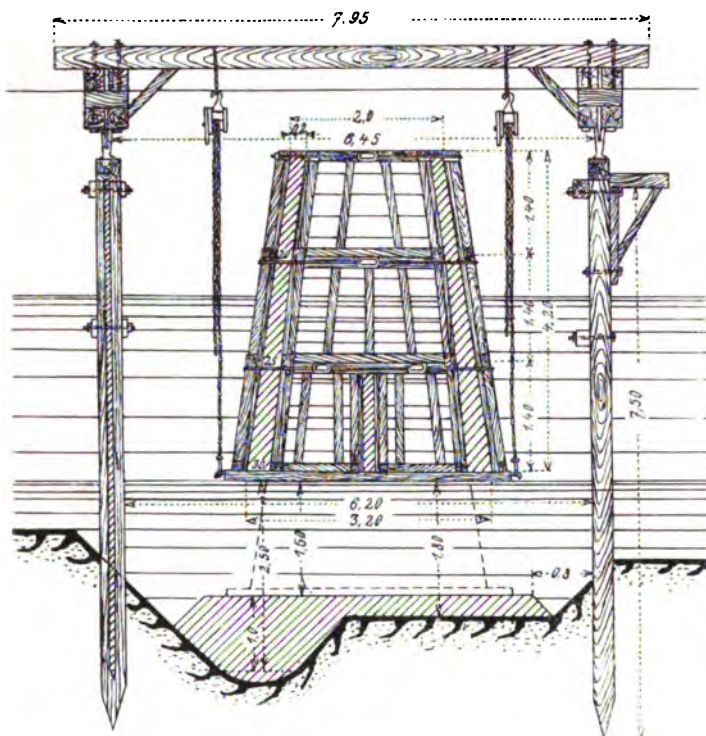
Einzelheiten zu dem Entwurf einer Kaimauer in Rotterdam.
